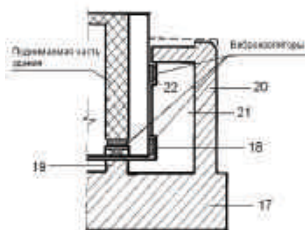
Схема виброизоляции цокольного этажа в основании здания.
